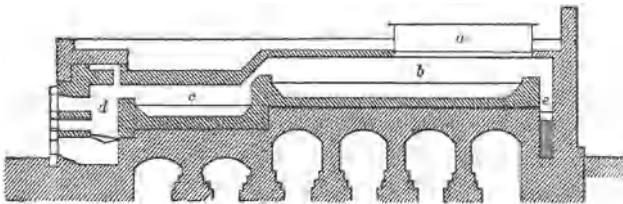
Längenschnitt eines Ofens zur Gewinnung von Schweissasche.
